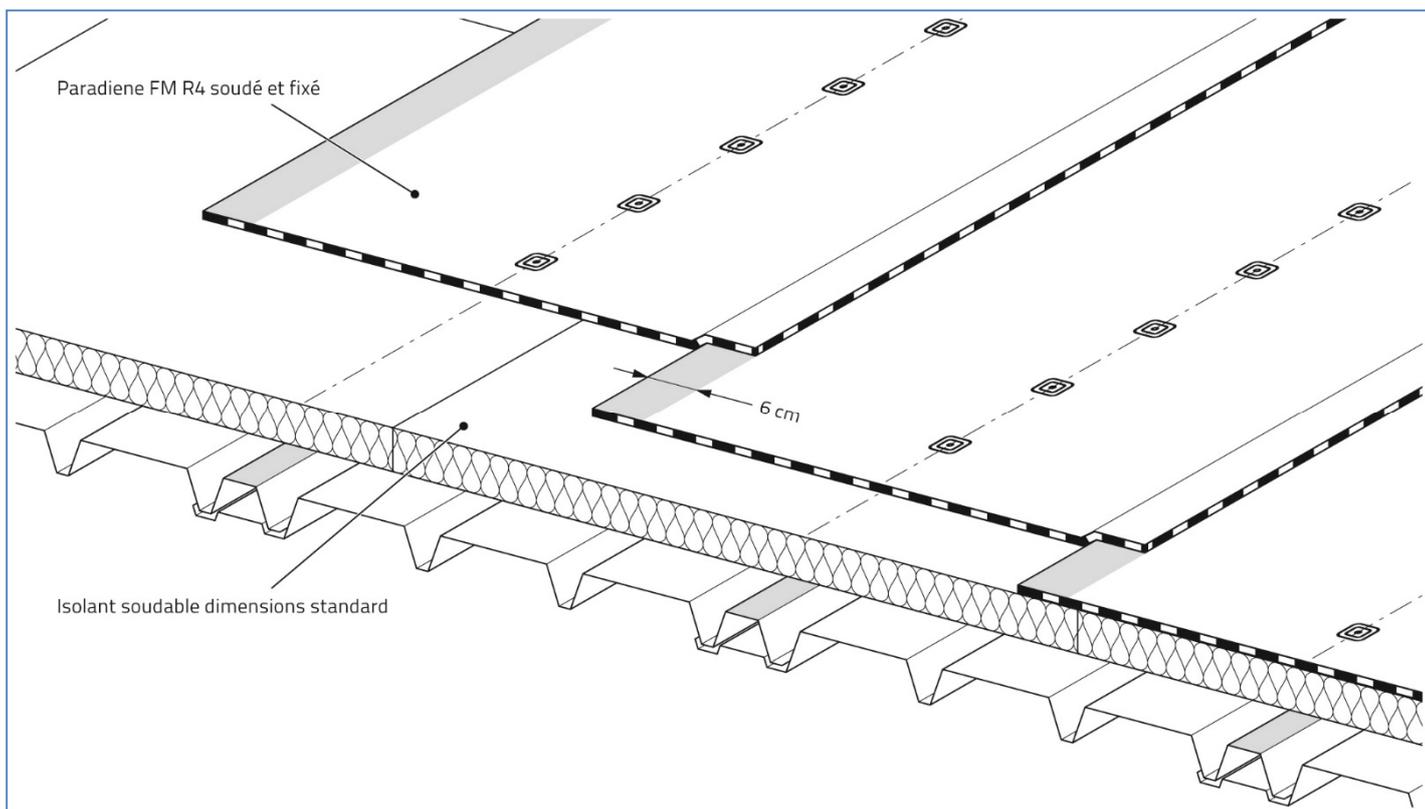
Revêtement d'étanchéité monocouche soudé et fixé mécaniquement
